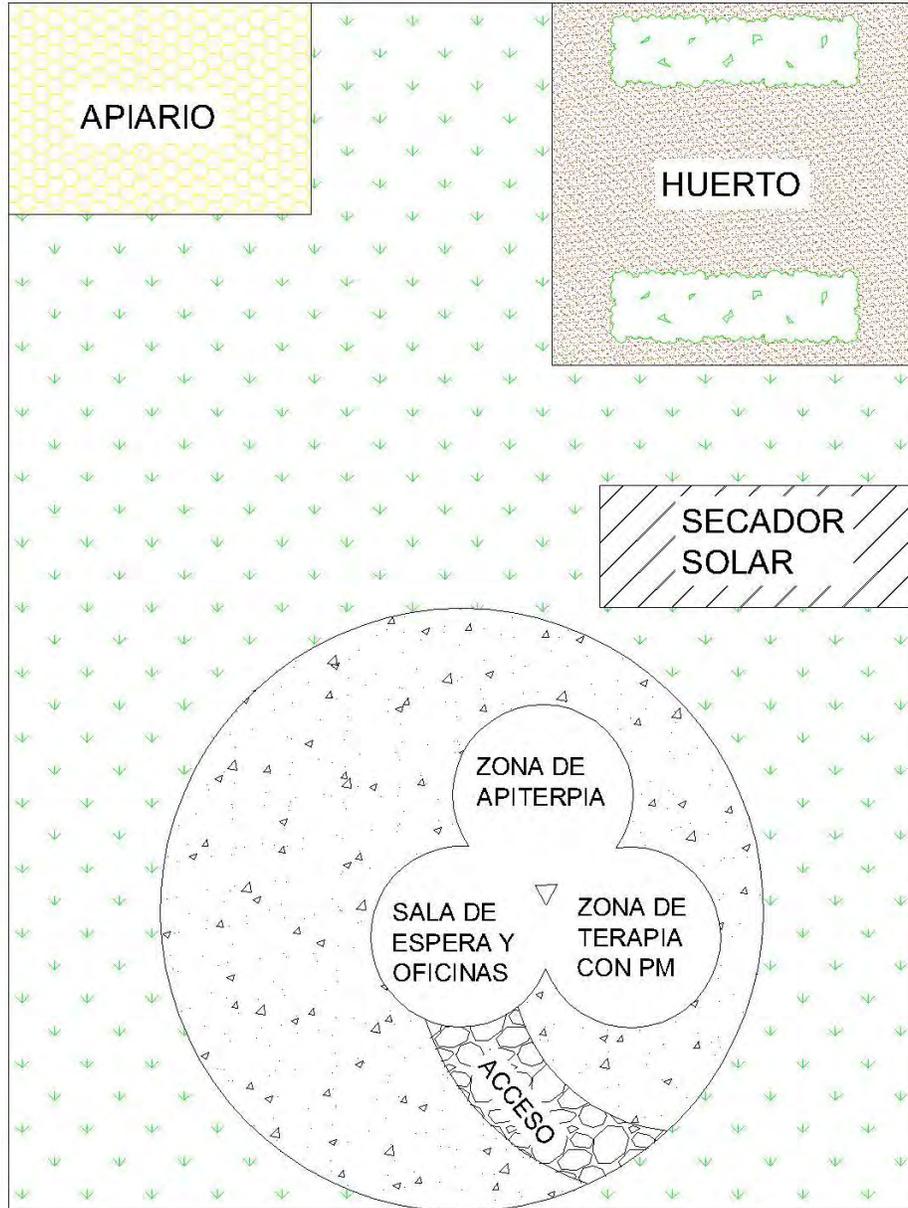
Plano general de distribución de zonas en el CMA. Elaboración: propia
